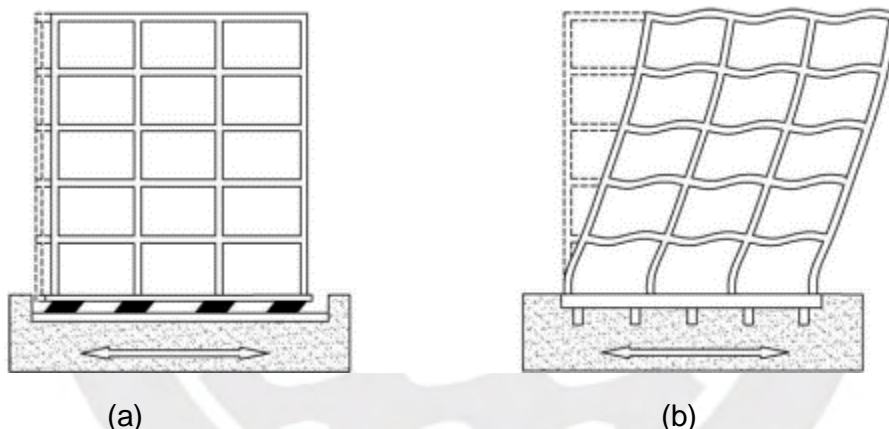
(a) Deformada de estructura aislada y (b) Deformada de estructura convencional
